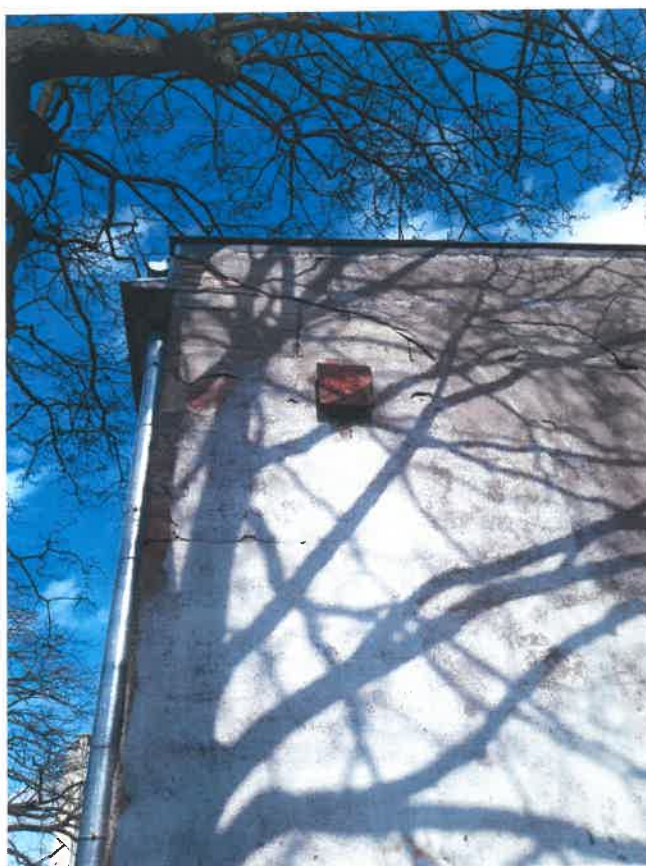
Elewacja południowa głównego budynku szkoły
